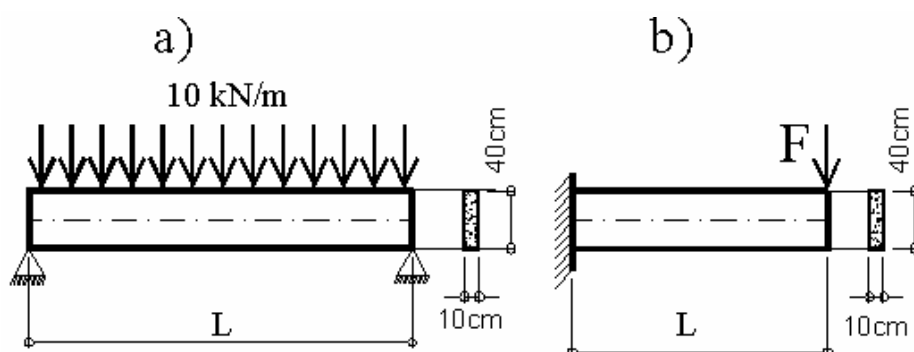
a) Viga bi-apoiada; b) Viga engastada.
